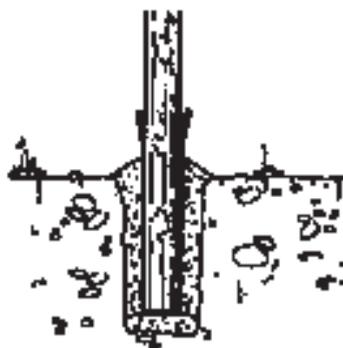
Sezione della fondazione del montante. (Tratto da: “Costruire in legno”. Manuale ARSIA). *Foundation section.* (From: “Costruire in legno”. Manuale ARSIA).
